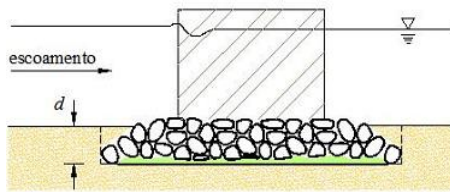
Corte esquemático de tapete de enrocamento com escavação.
